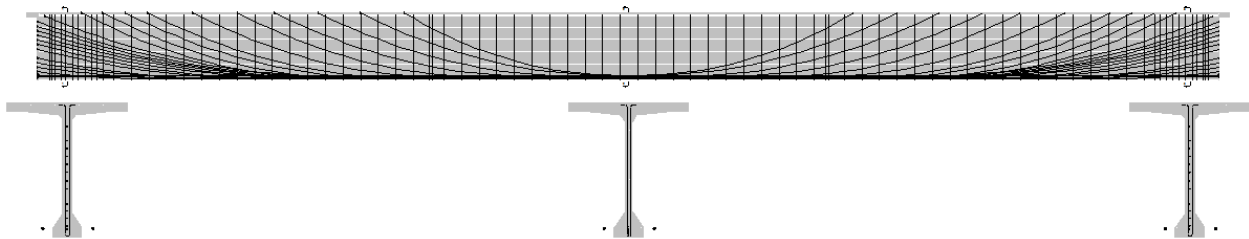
Poutre type modélisée avec toute l'armature passive ainsi que les câbles de précontrainte interne et externe
